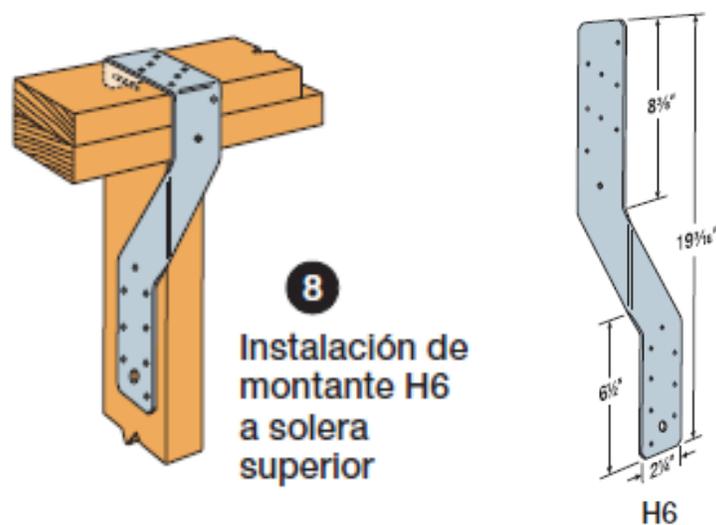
Refuerzo de conexión entre el Piederecho y la solera superior. (Simpson strong tie, 2019) Ver Nota 1
